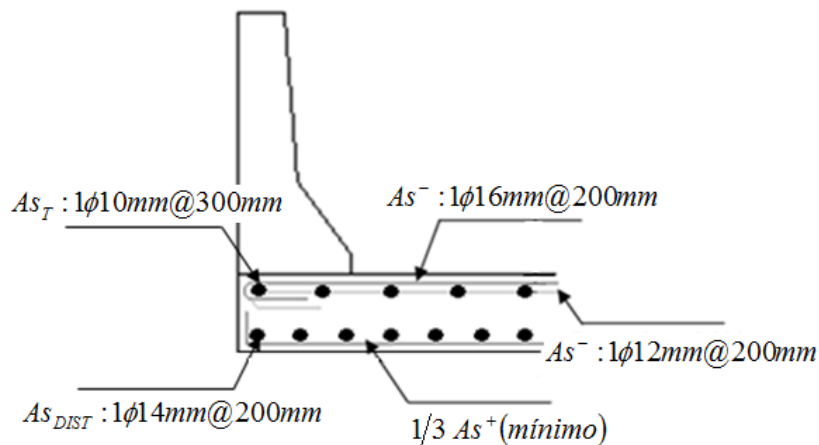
Armado en tablero (losa-voladizo) corte transversal
